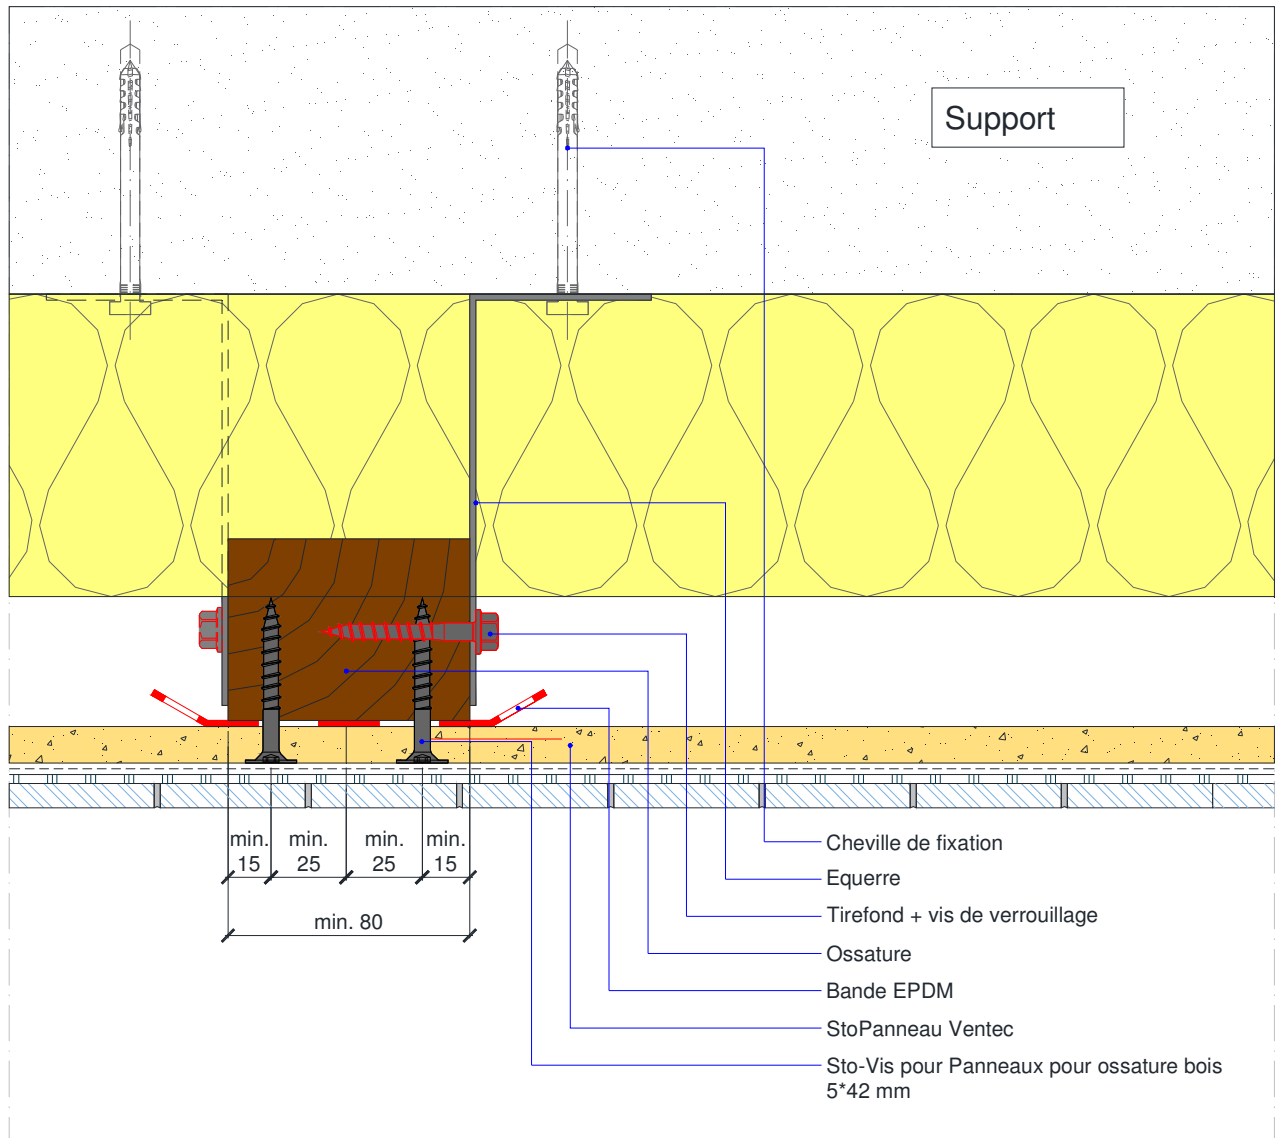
Fixation directe sur le support – Ossature bois – Coupe horizontale
